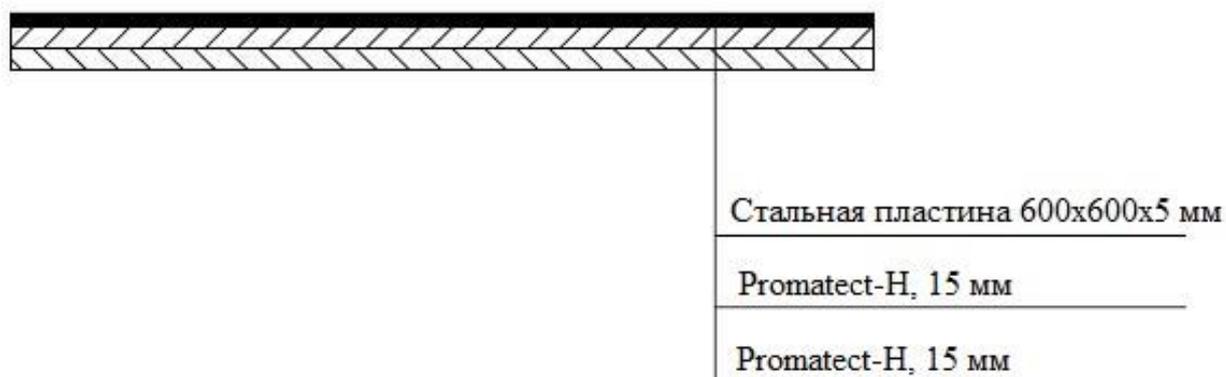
Схема сборки системы конструктивной огнезащиты
